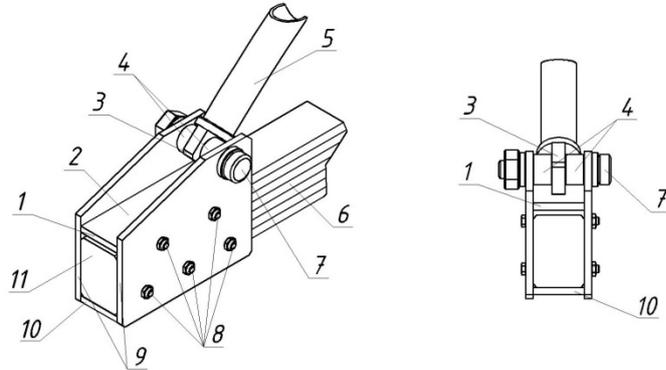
Узел примыкания арки к балке: 1 – верхняя планка; 2 – башмак; 3 – серьга; 4 – втулки; 5 – арка; 6 – балка (затяжка); 7 – палец; 8 – болты; 9 – боковые щеки; 10 – нижняя планка; 11 – торец башмака
